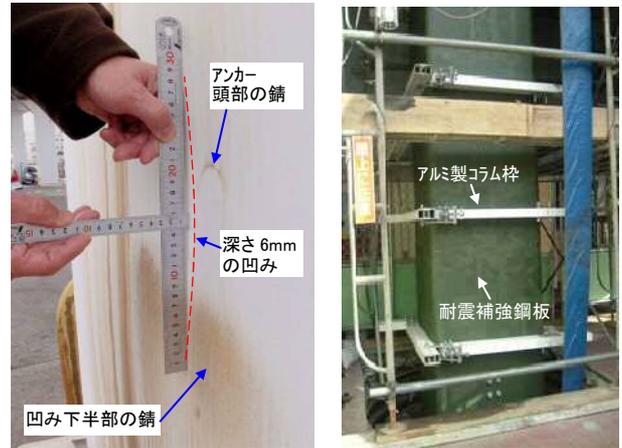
塗装劣化状況の詳細 写真-3 従来のはらみ出し防止
